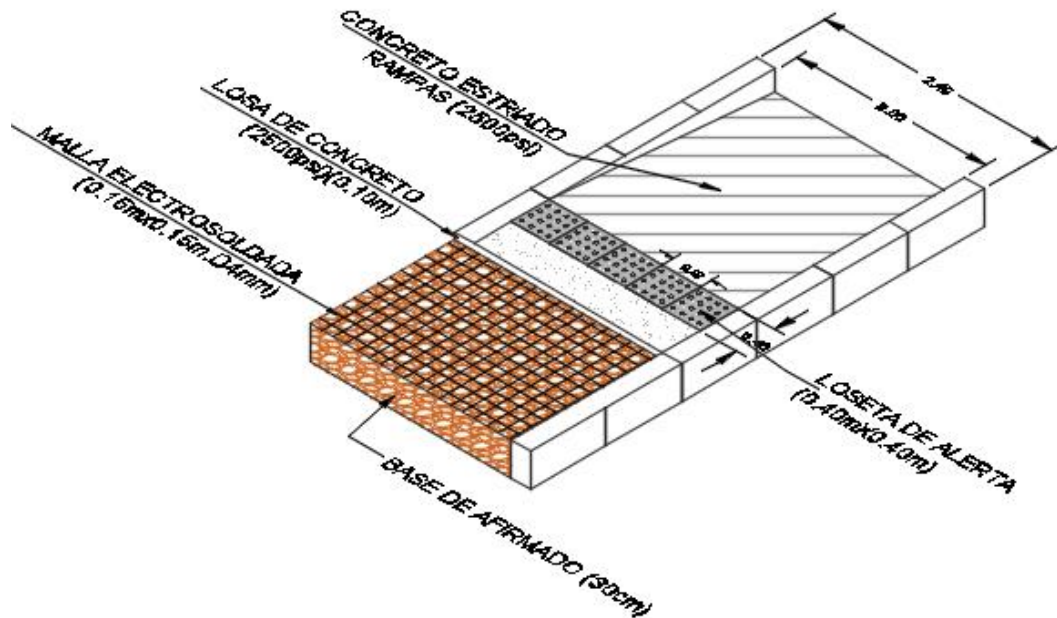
Vista en planta diseño geometría anden barrio La María.
